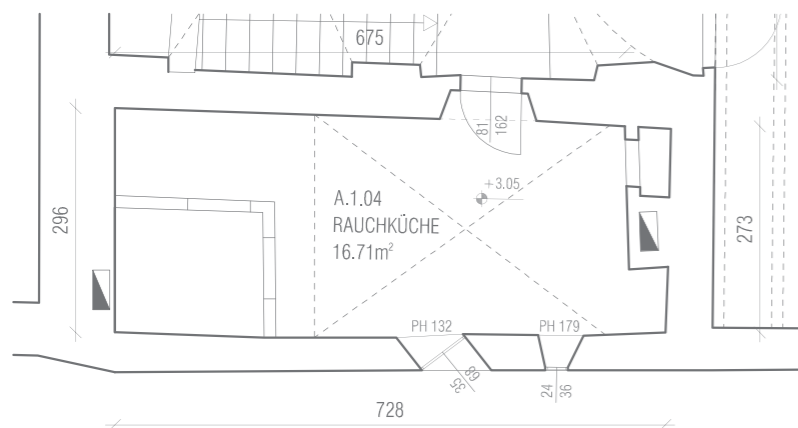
Grundriss Raum A.1.04_1:100
